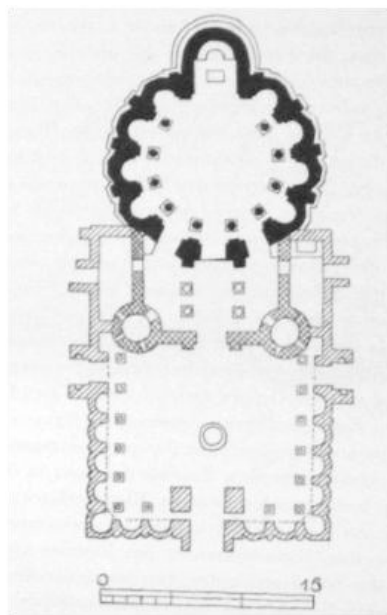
Grundriss, Palastkapelle von Preslav, Bulgarien, Anfang 10. Jh.
